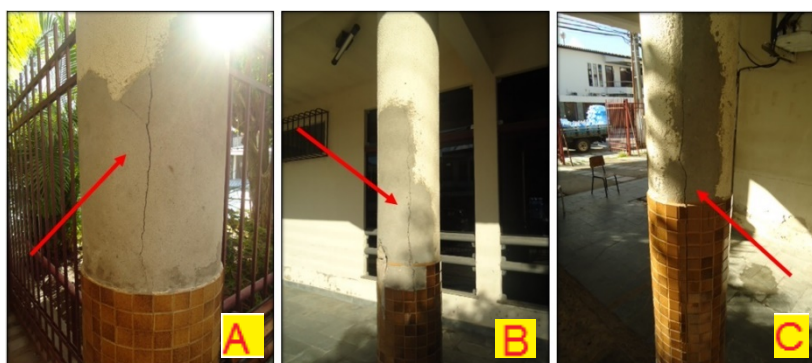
Fissuras nos pilares da fachada da SEMED
